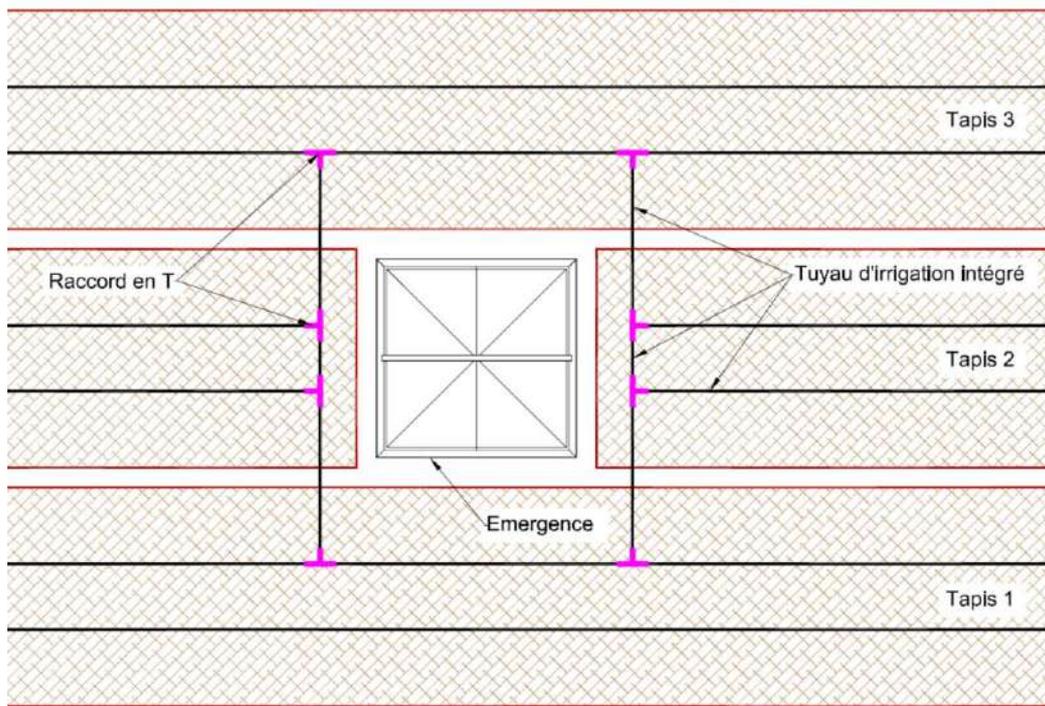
Schéma de principe du système d'irrigation - Contournement d'une émergence en toiture - cas 1
